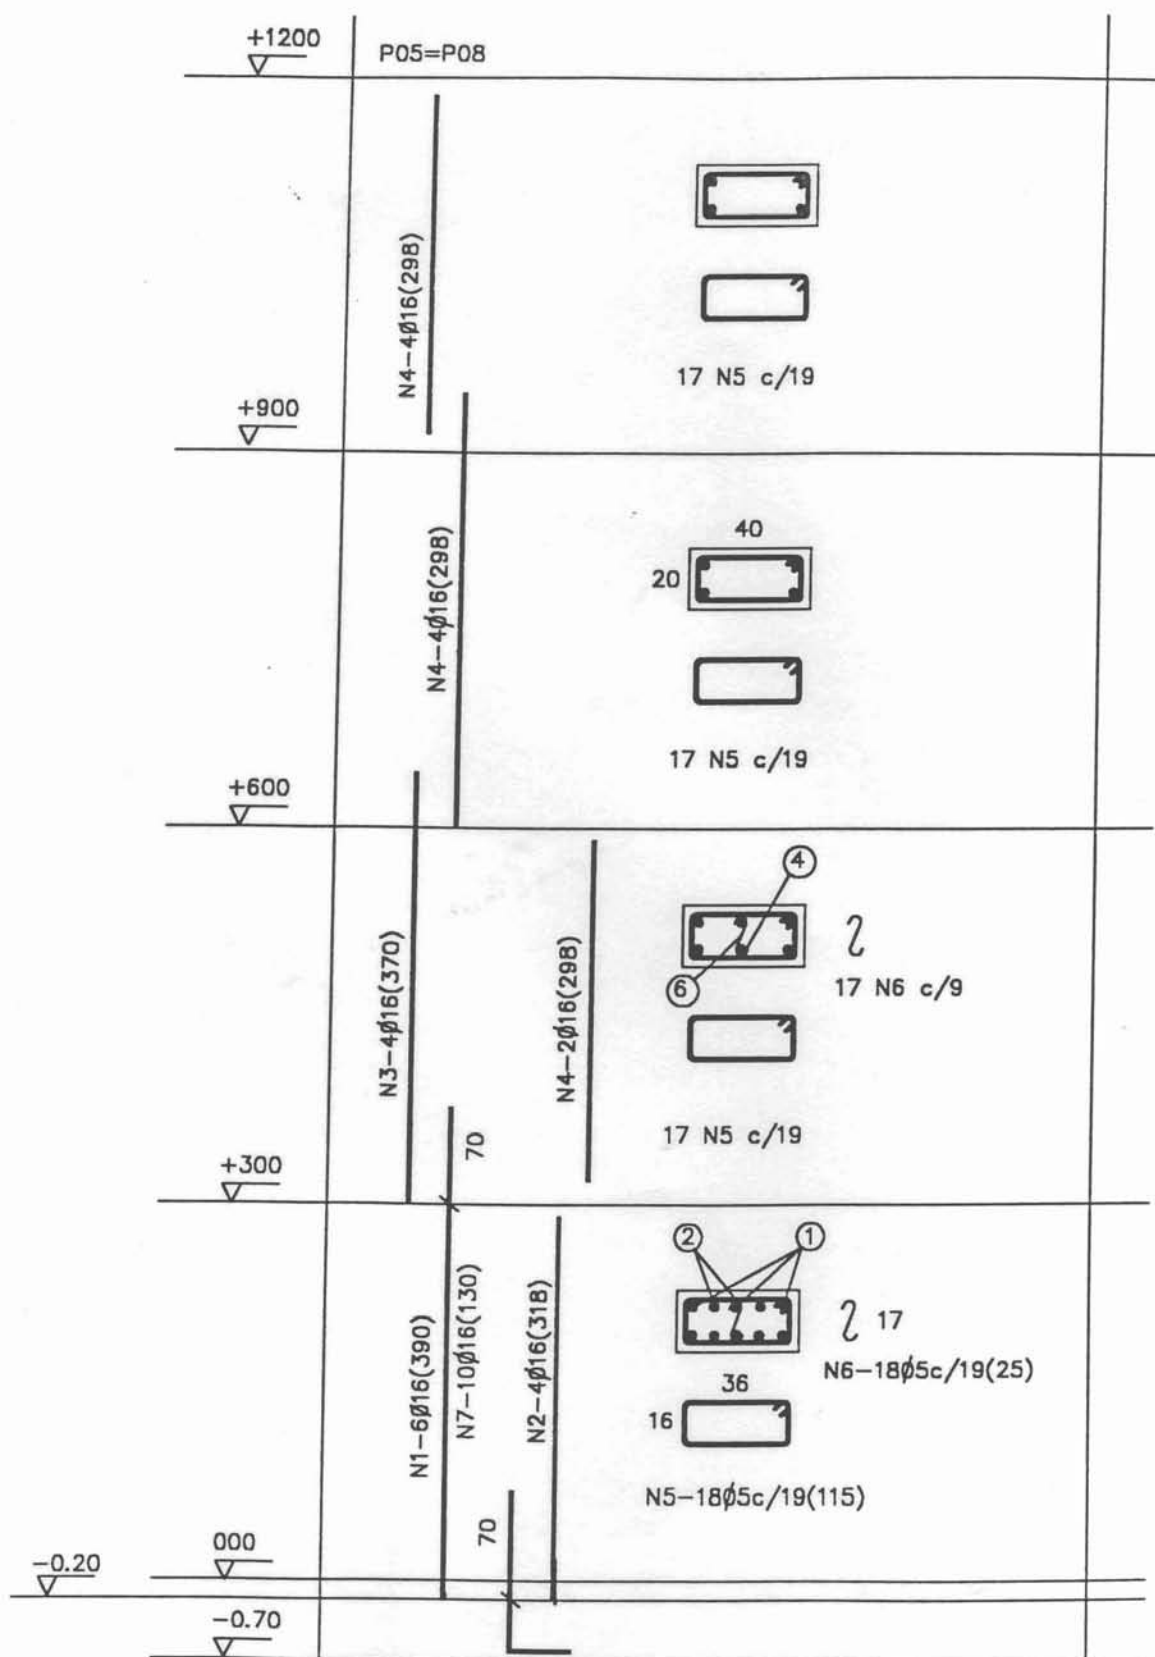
Detalhamento dos pilares P05 e P08
